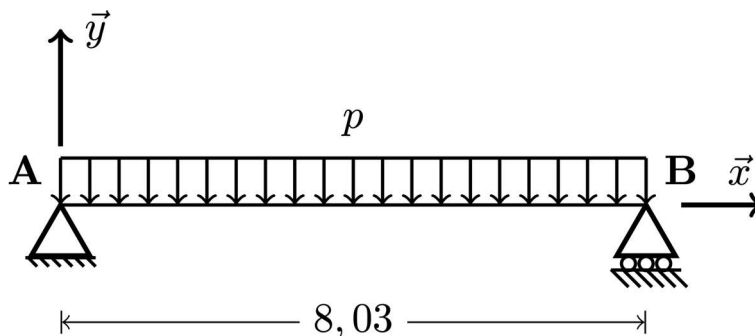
Poutre isostatique, plancher haut, sous poids propre
